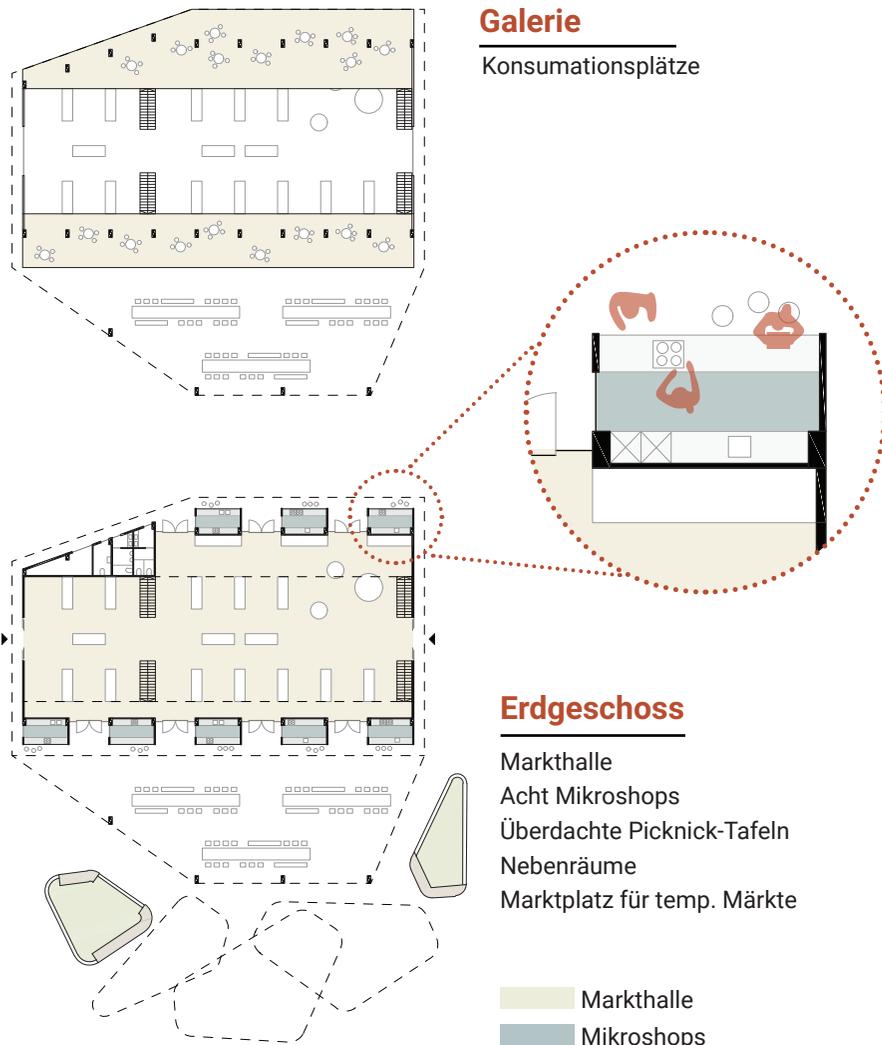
Markthalle und Marktplatz, Grundrisse M 1:700 [PS, 2018]
